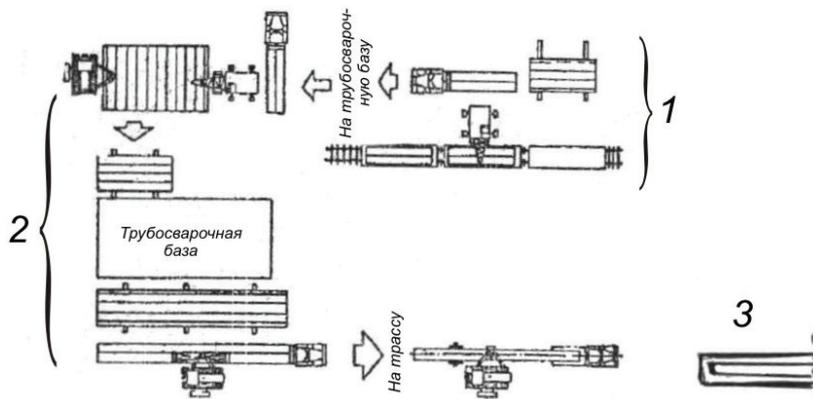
Сварочно-базовая схема выполнения сварочных работ
